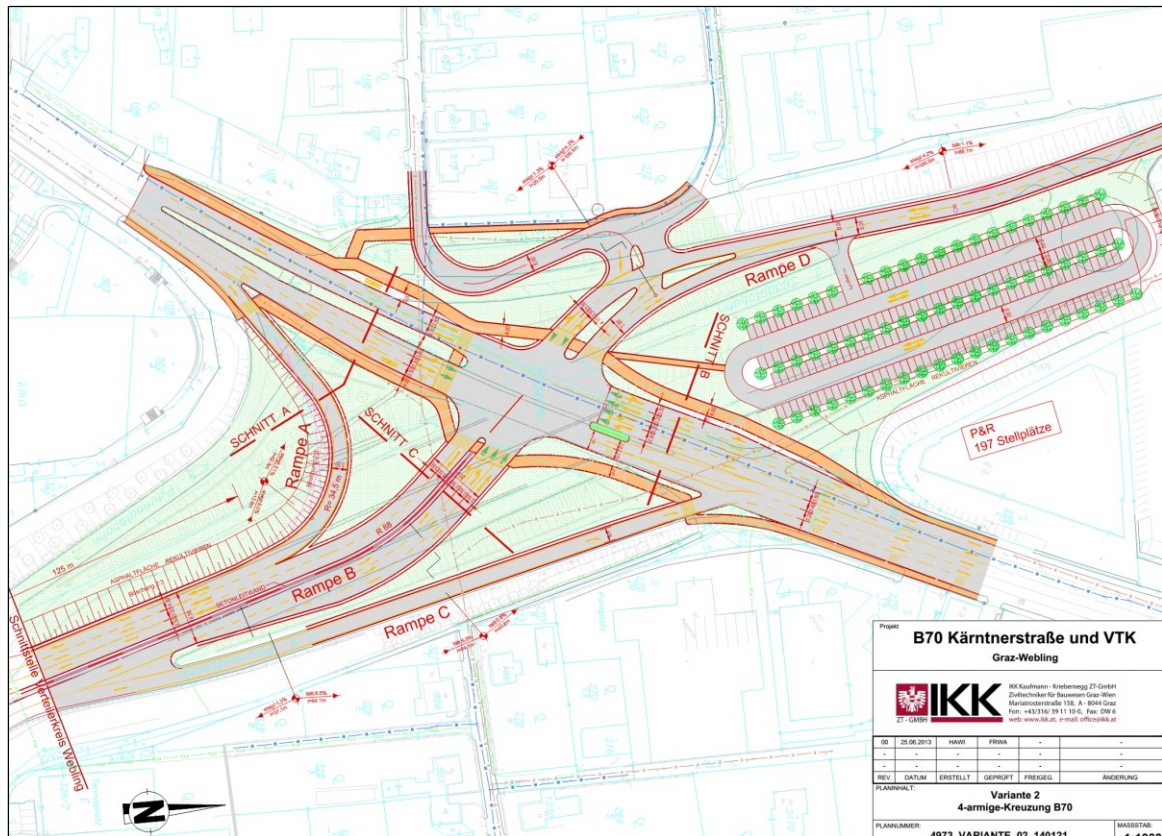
Lageplan Variante 2 - niveaugleiche Kreuzung
